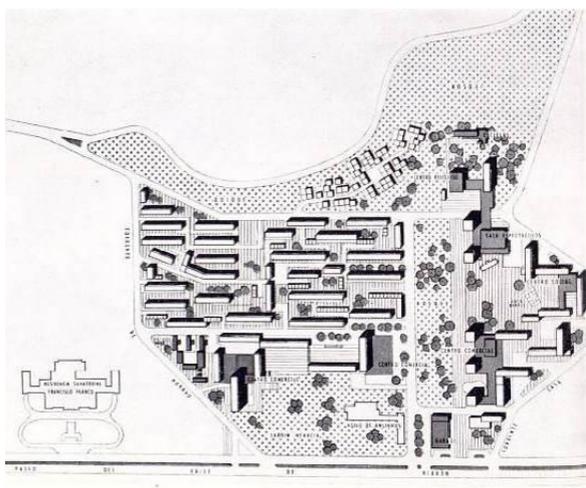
Primer Plan Parcial de Ordenación Montbau, aprobado en 1957.
